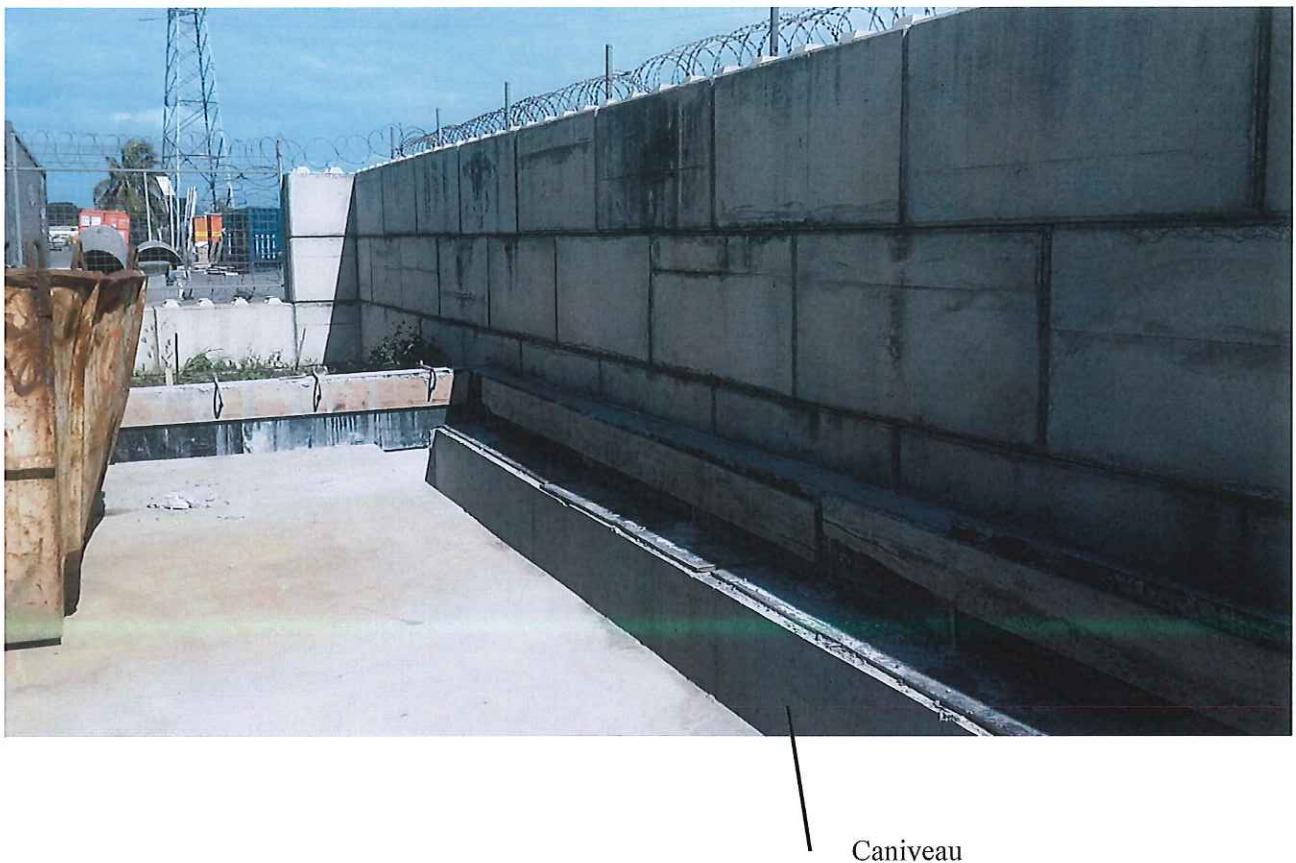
dalles fabriquées pour recouvrir le caniveau à la périphérie Nord du site (vue en direction de l'Est)
